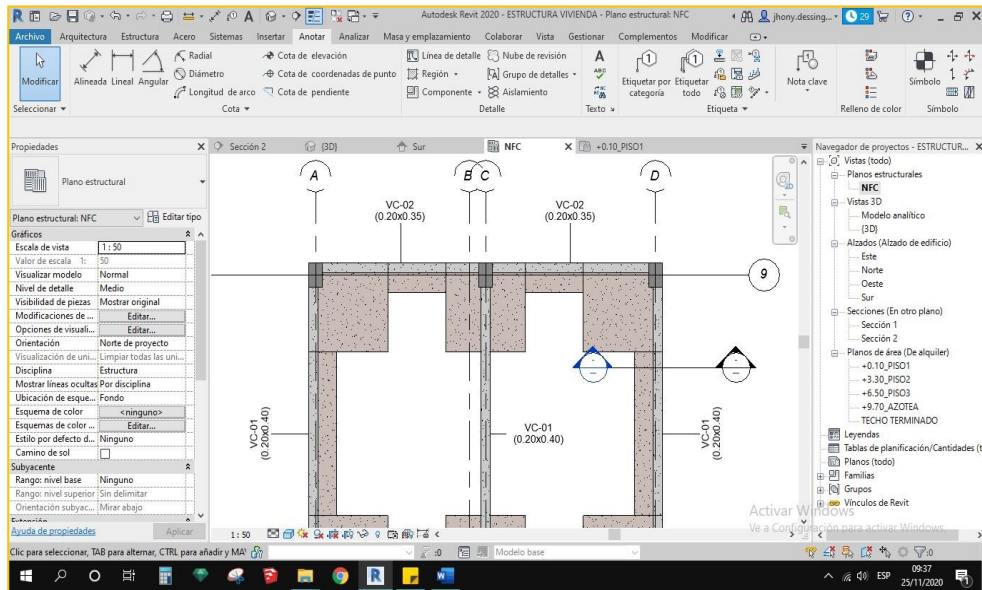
Creación de vigas de cimentación tipo VC-02 en eje X.
